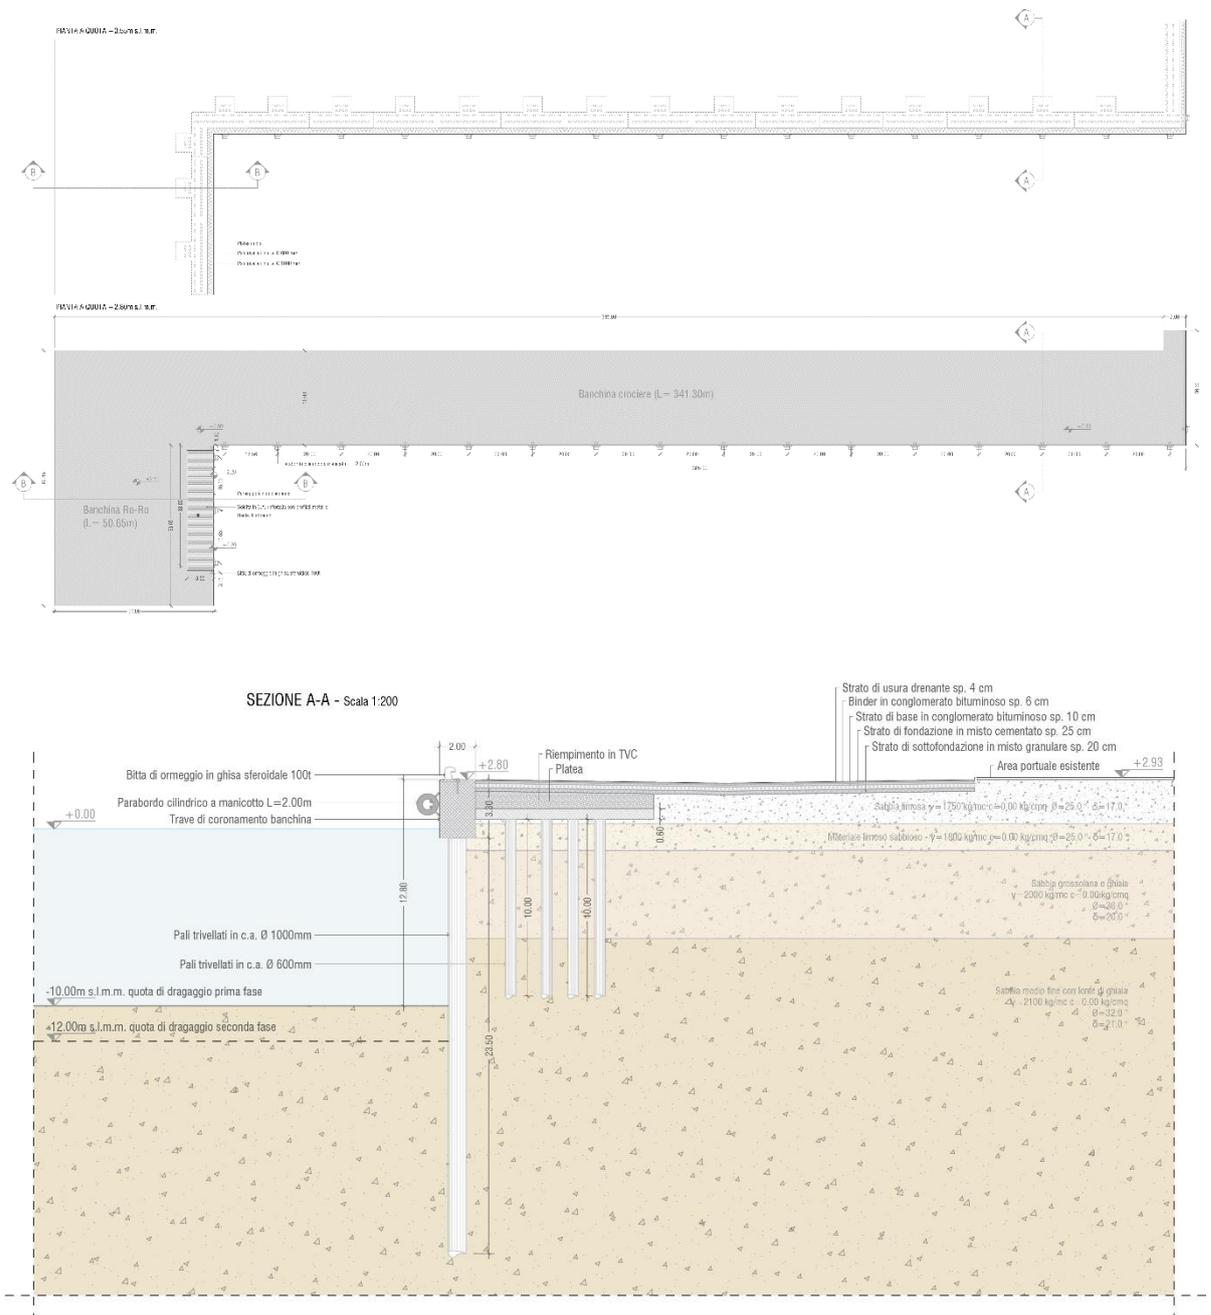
Banchina di progetto -Pianta e sezioni tipo (Elab. EG.09)
